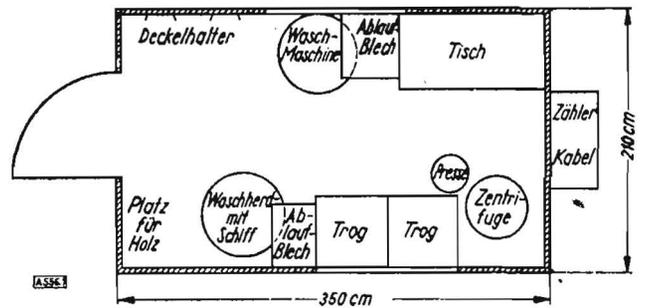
Plan der Einrichtung einer fahrbaren Waschküche
